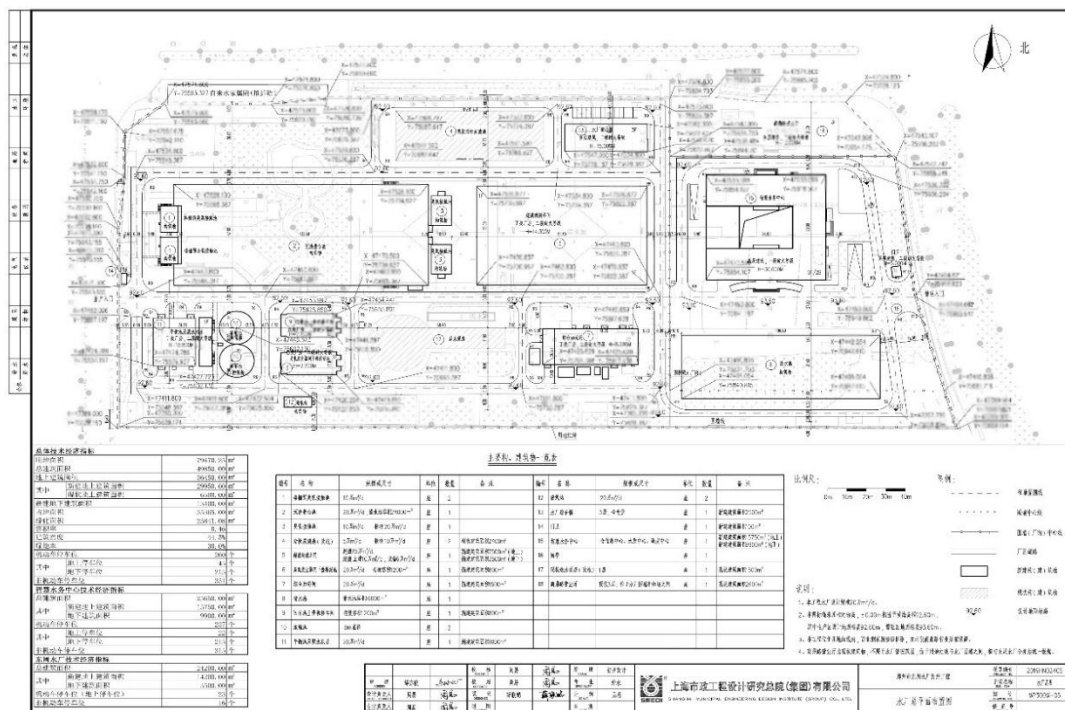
《郑州市东周水厂提升工程修建性详细规划》（方案）总平面图
